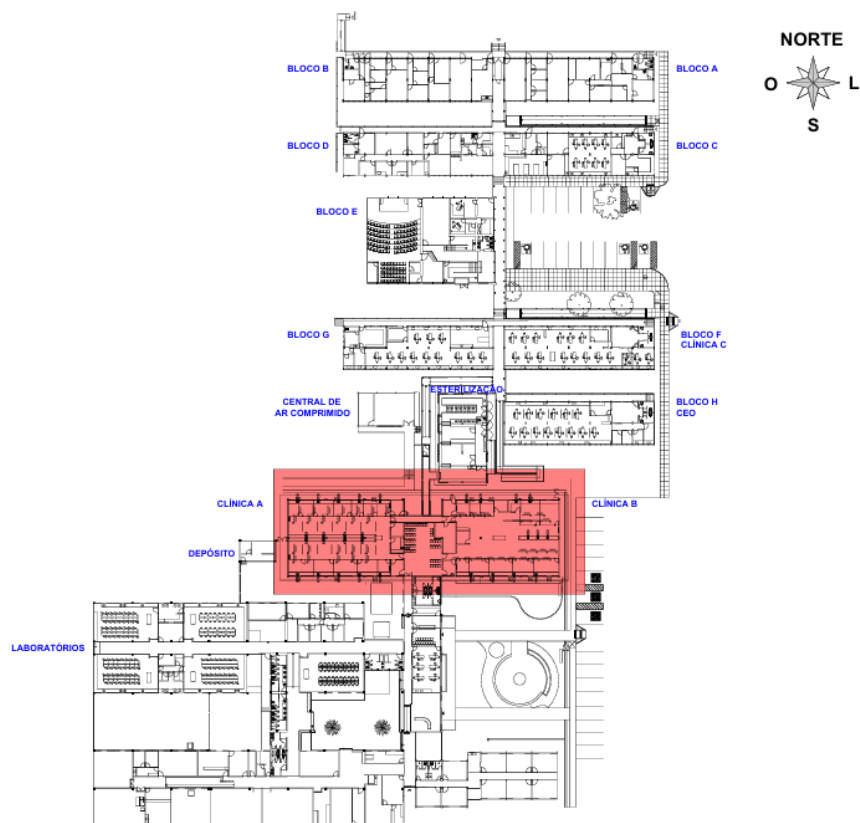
Planta chave – Odontologia. Fonte: Acervo da autora(2026).
